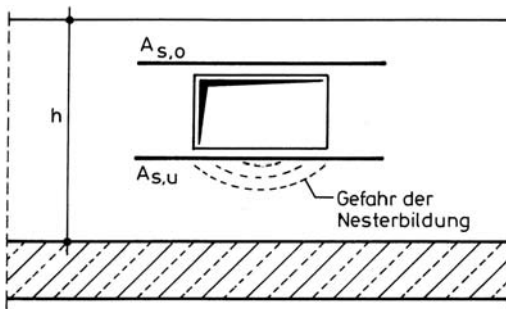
Anordnung der horizontalen Zulagebewehrung im Bereich von Fensteröffnungen (aus [7])
